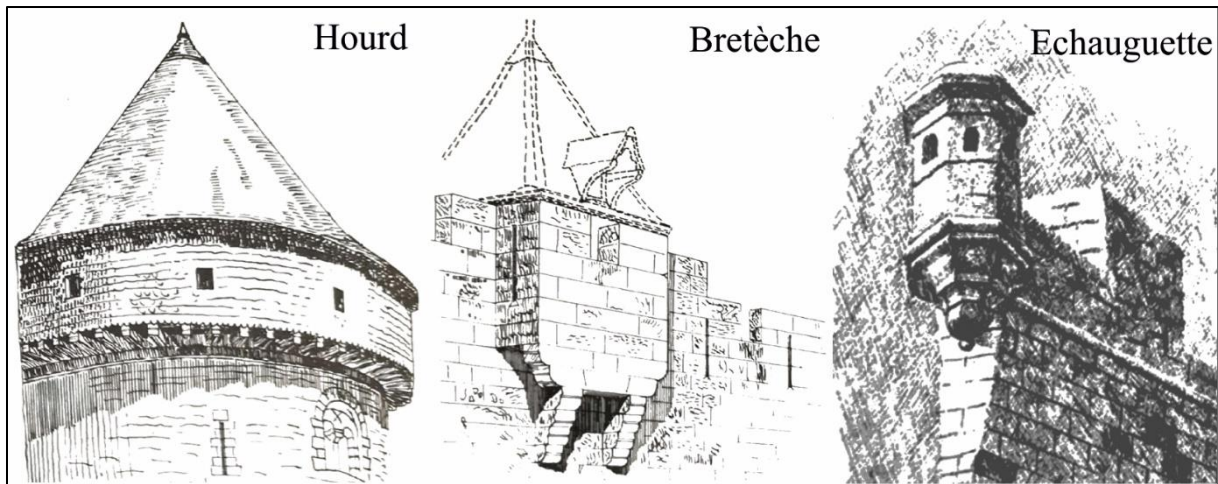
Dispositif de défense au pied du mur. Source Pierre RECOLLE⁸⁸
